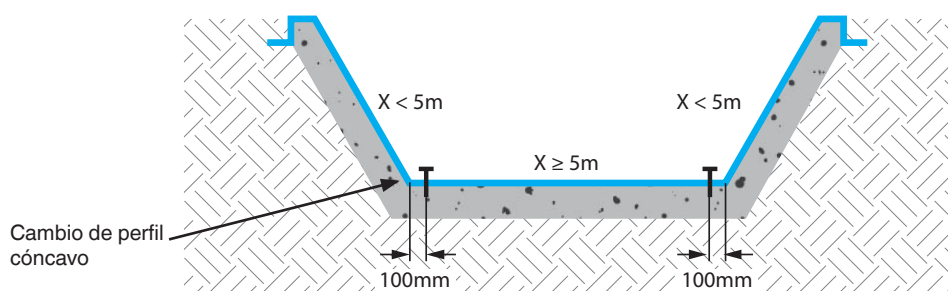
Fijación a 100 mm del cambio de perfil cóncavo por base ≥ 5 m
